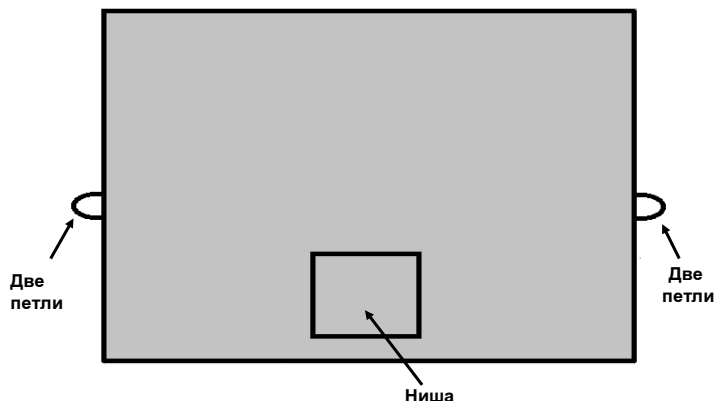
Вид сбоку на корпус колодца «ККСр-1-10(80)».
